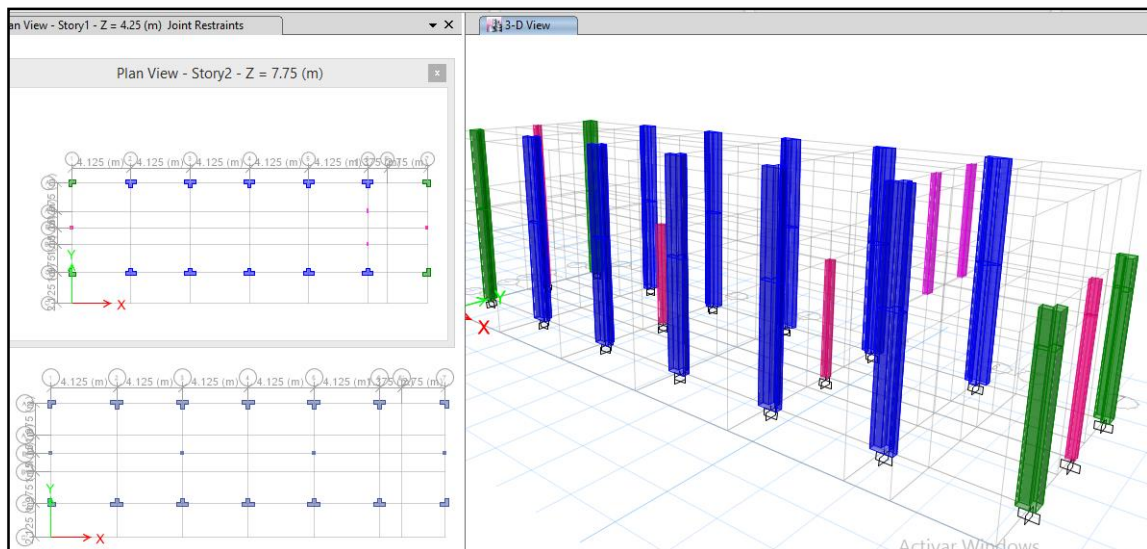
Dibujo de todas las columnas del sistema estructural del módulo VI.
